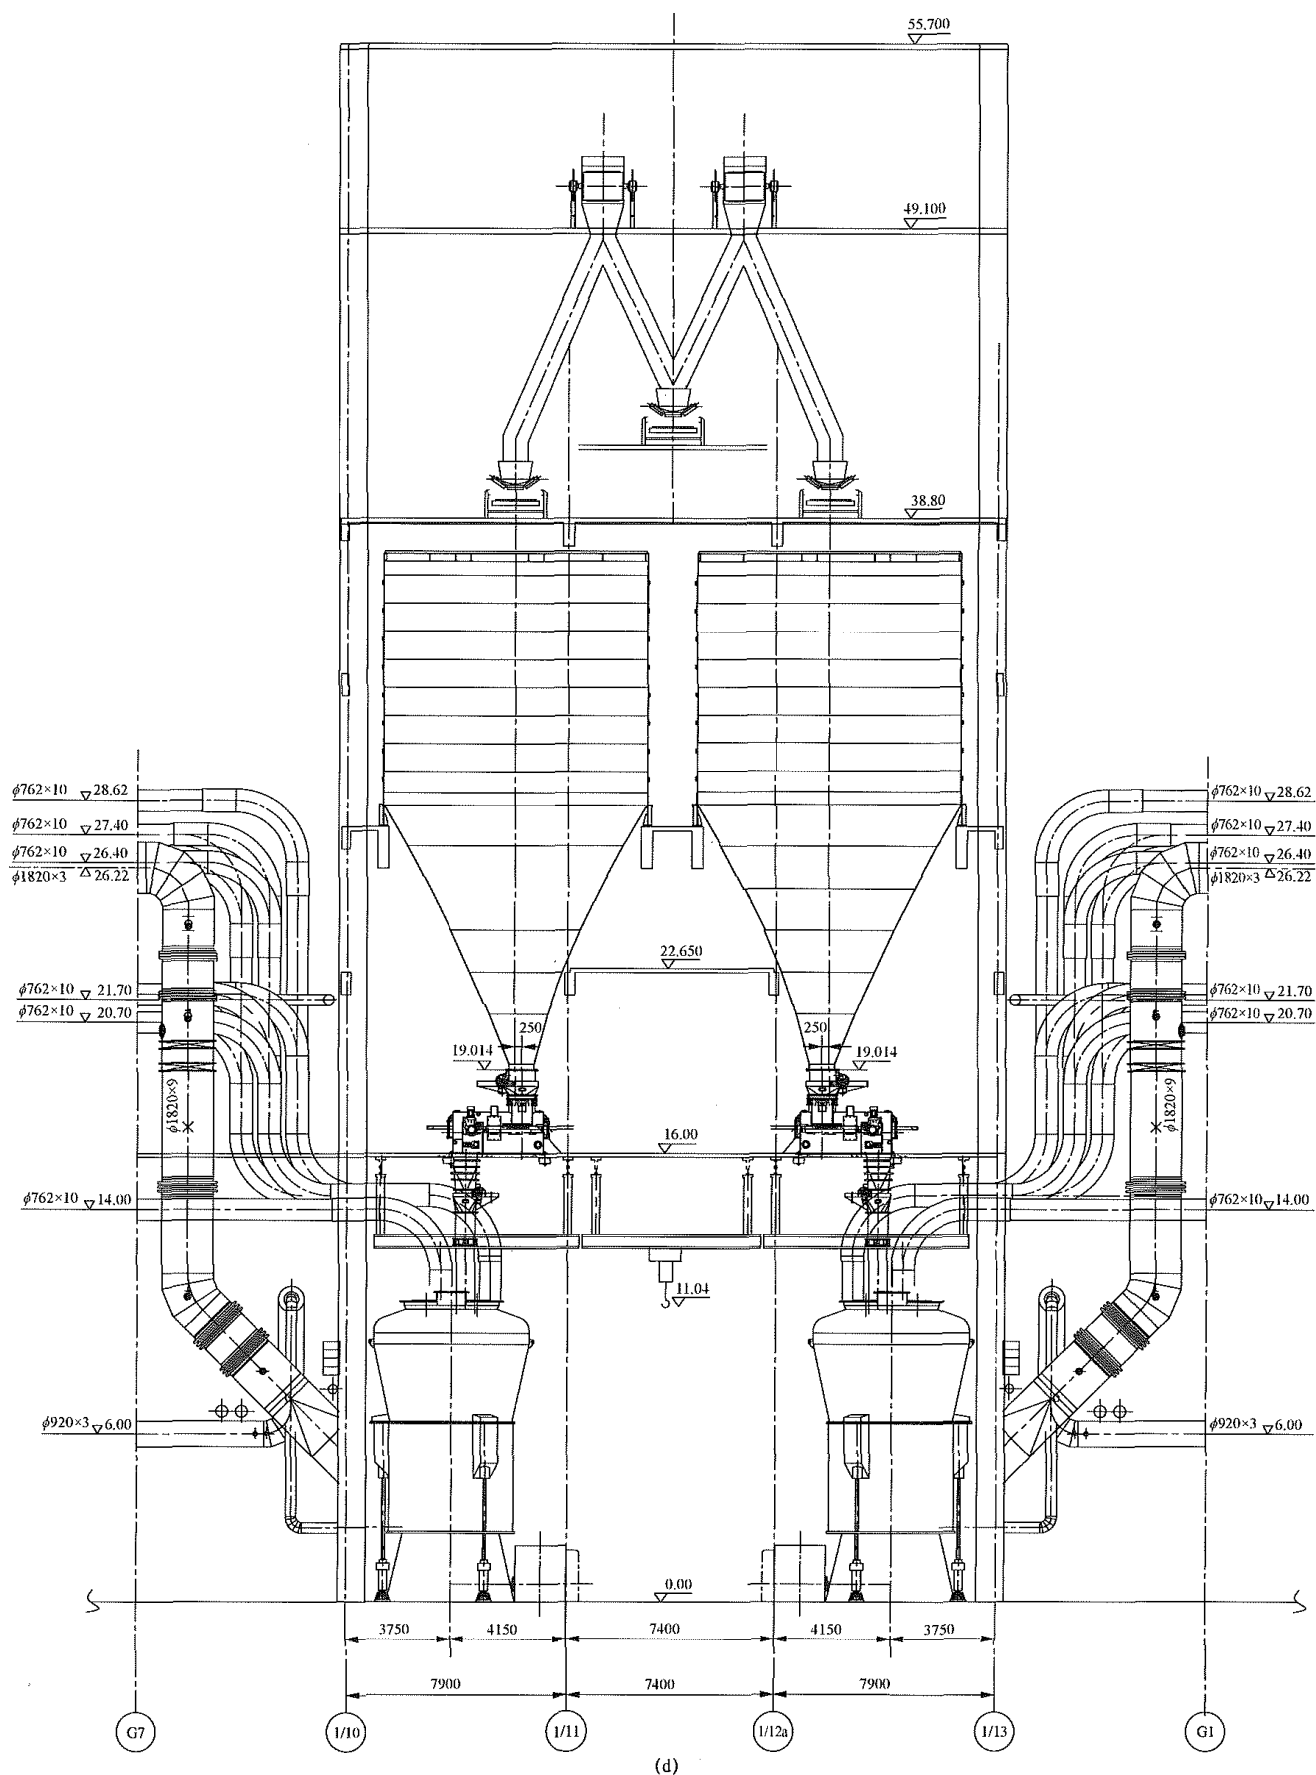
MPS 轮式磨煤机侧煤仓方案平面布置示意图 (四)
